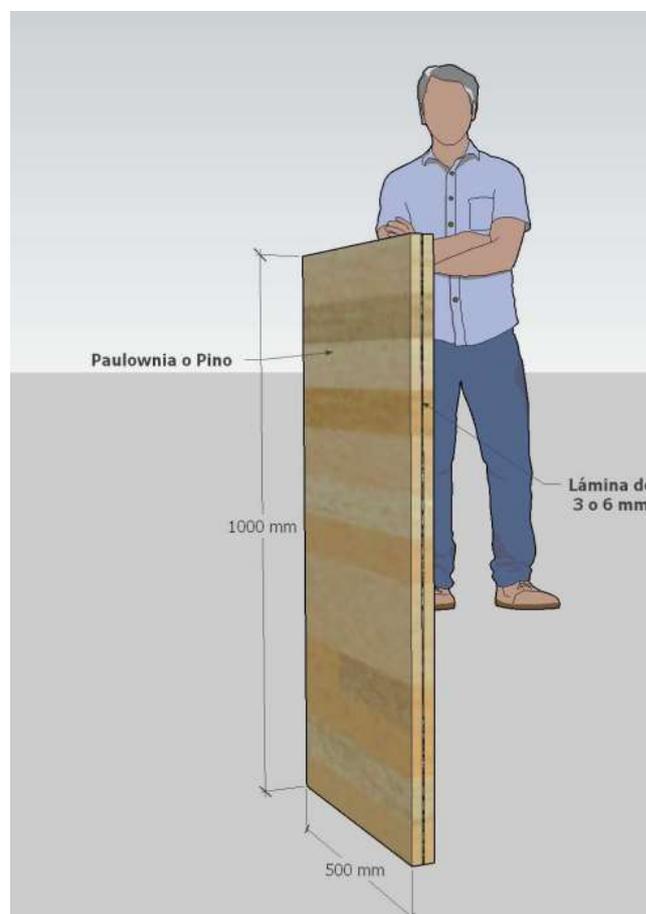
Ejemplo de panel prefabricado para instalación en obra
